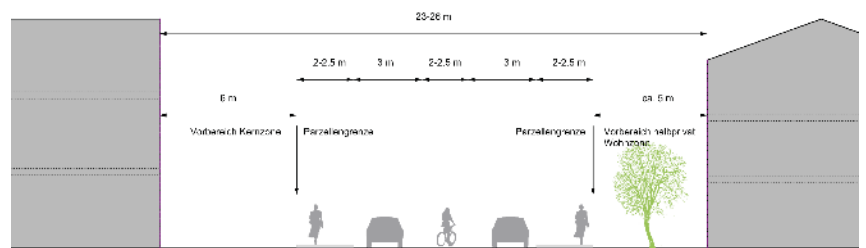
Schemaschnitt Winznauerstrasse, Abschnitt 1
